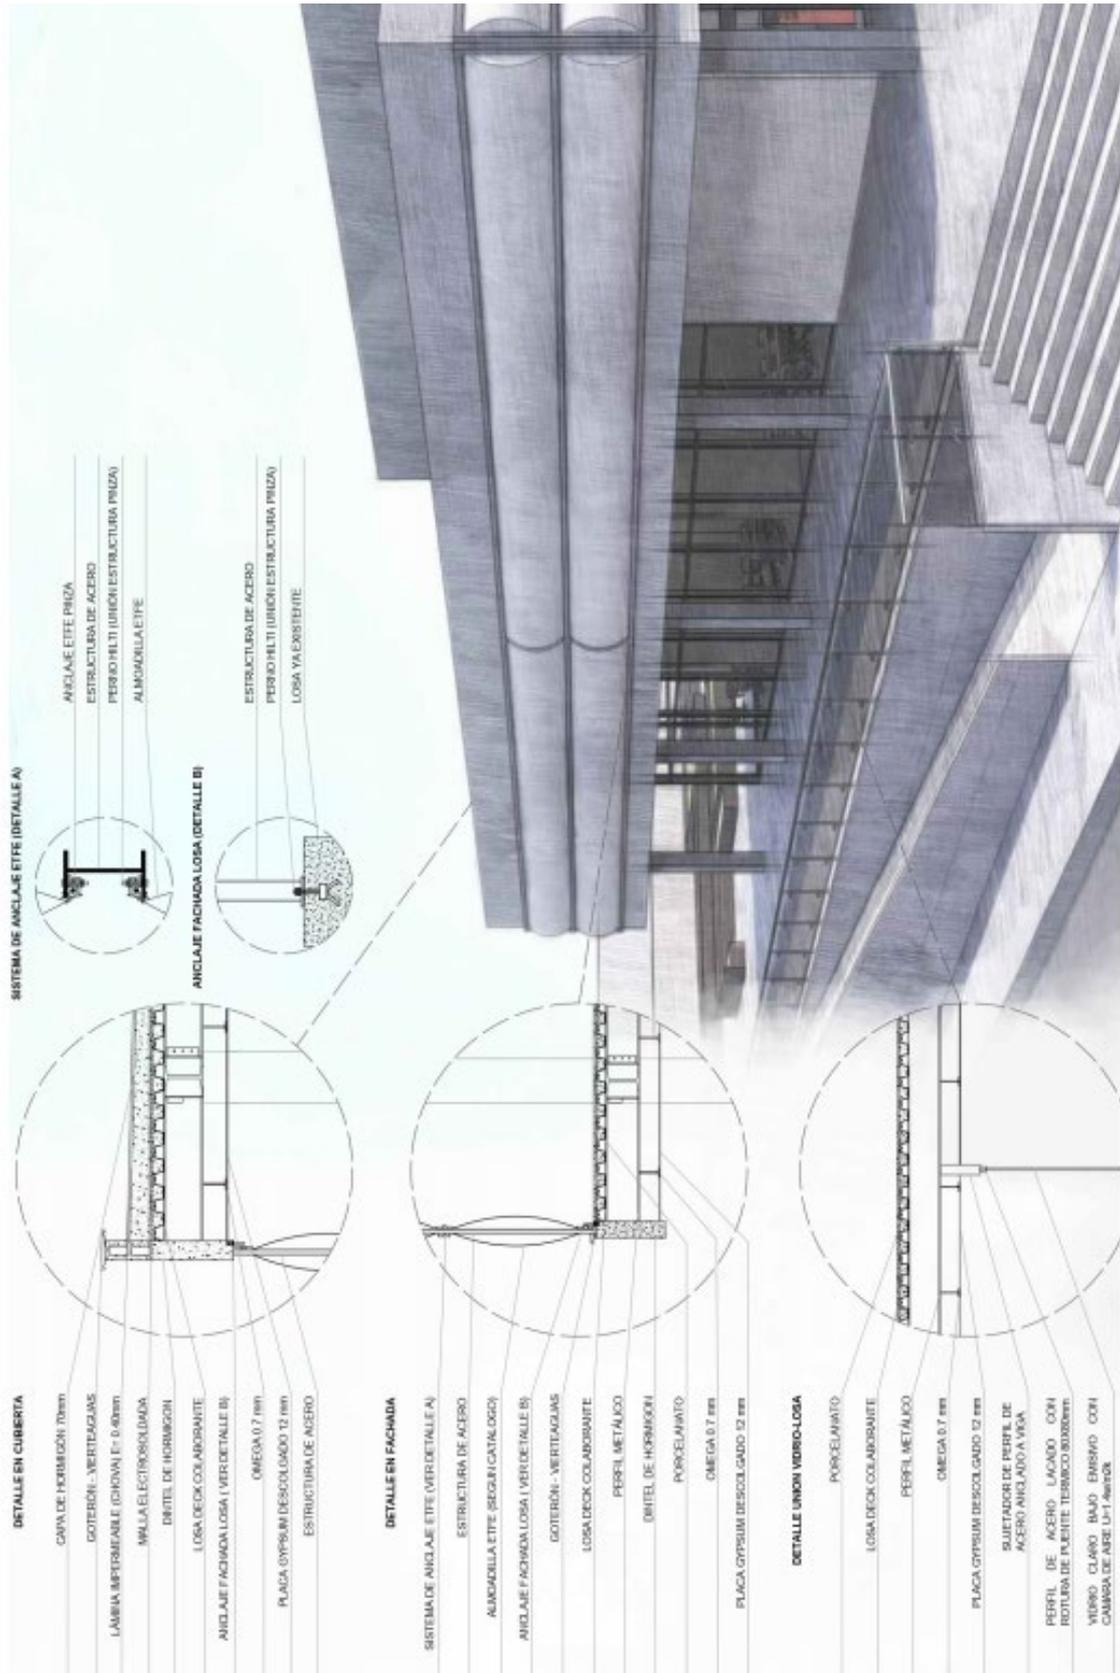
Detalle constructivo ETFE. Elaboración propia.
